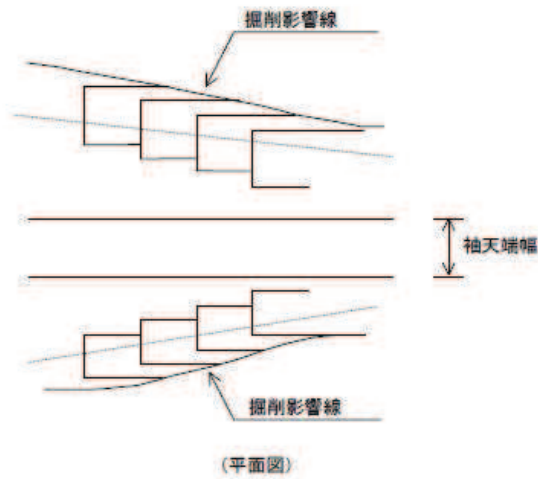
間詰め設計(間詰コンクリートが階段状の場合)
